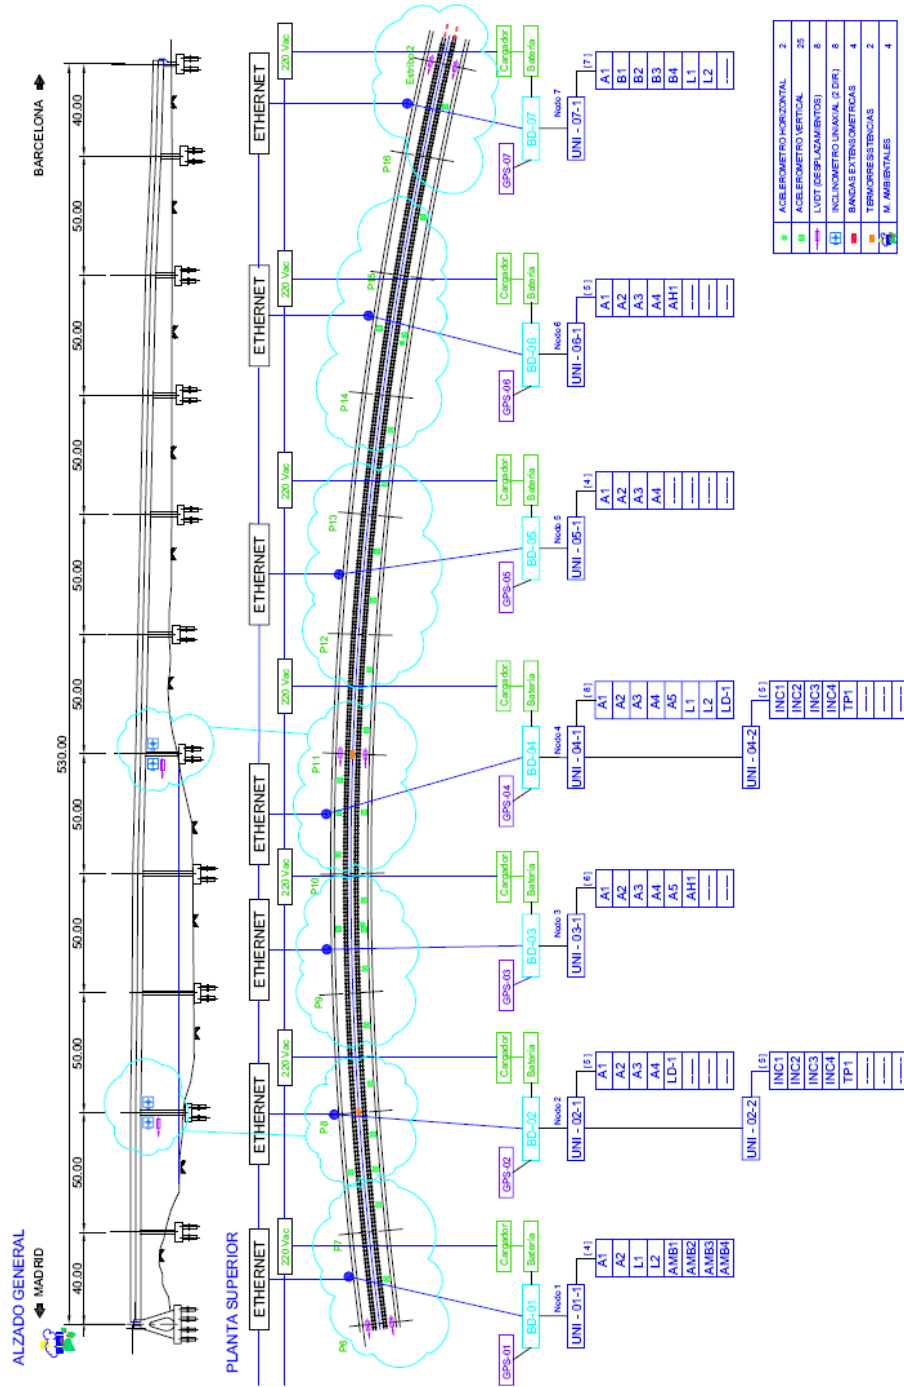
Plano de Instrumentación del viaducto de Sanboi (hormigón). Cortesía del CEDEX.
